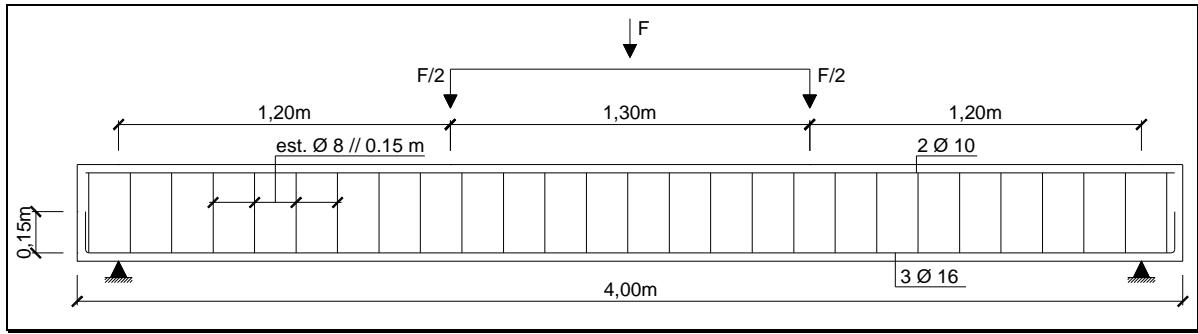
Secção longitudinal das vigas de referência e das vigas em aço inoxidável AISI316 da 2.ª série.
